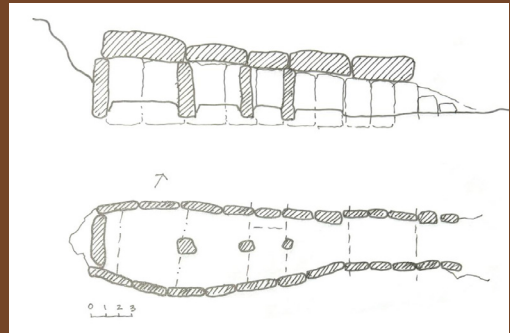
Planta y sección de la Cueva de Menga, Antequera, Málaga, 3000 AC<sup>2</sup>
